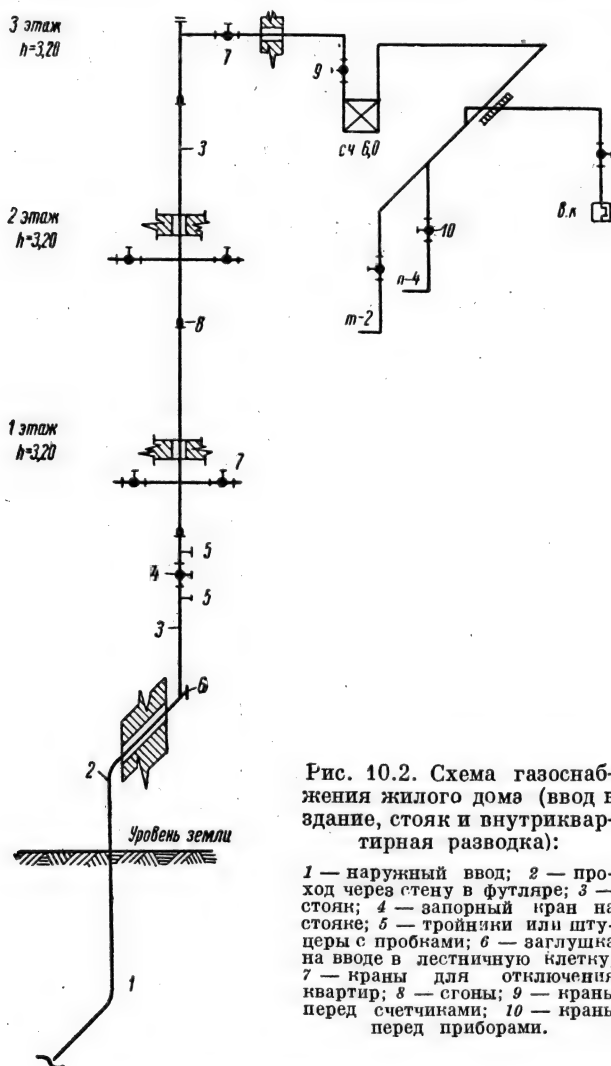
Схема газоснабжения жилого дома (ввод в здание, стояк и внутриквартирная разводка):
